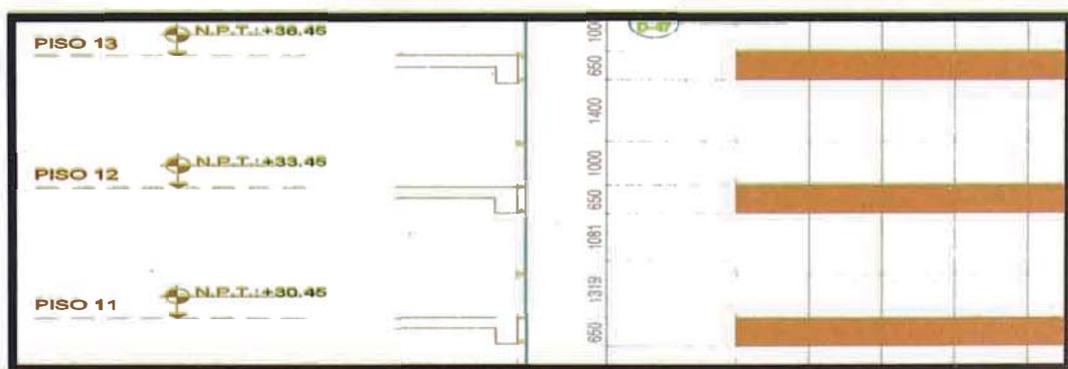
(Corte general de Arquitectura Furukawa original - Sin Alféizar en fachada-Caja de sombra cubre peralte de la viga.
